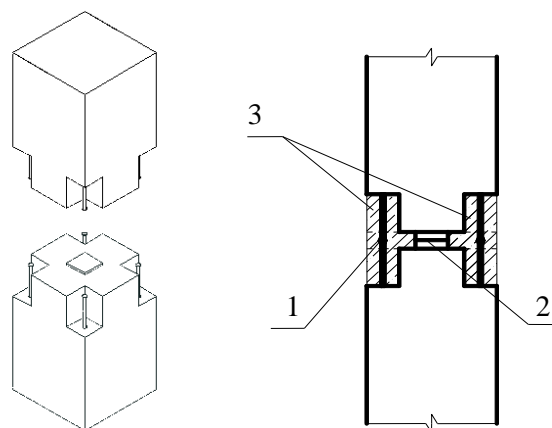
Îmbinarea coloanelor structurilor cu 6 nivele (seria ИИС-04-10): 1 – sudare prin baie; 2 – garnitură din armociment; 3 – beton de monolitizare.
